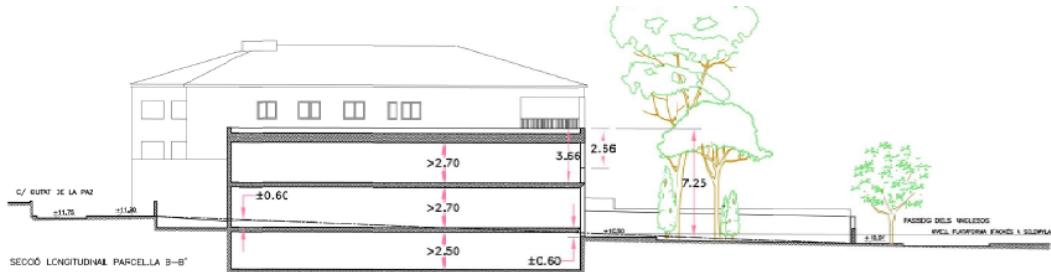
Justificació de la cota de referència de la planta baixa amb el manteniment de l'alçada màxima de l'edificació
